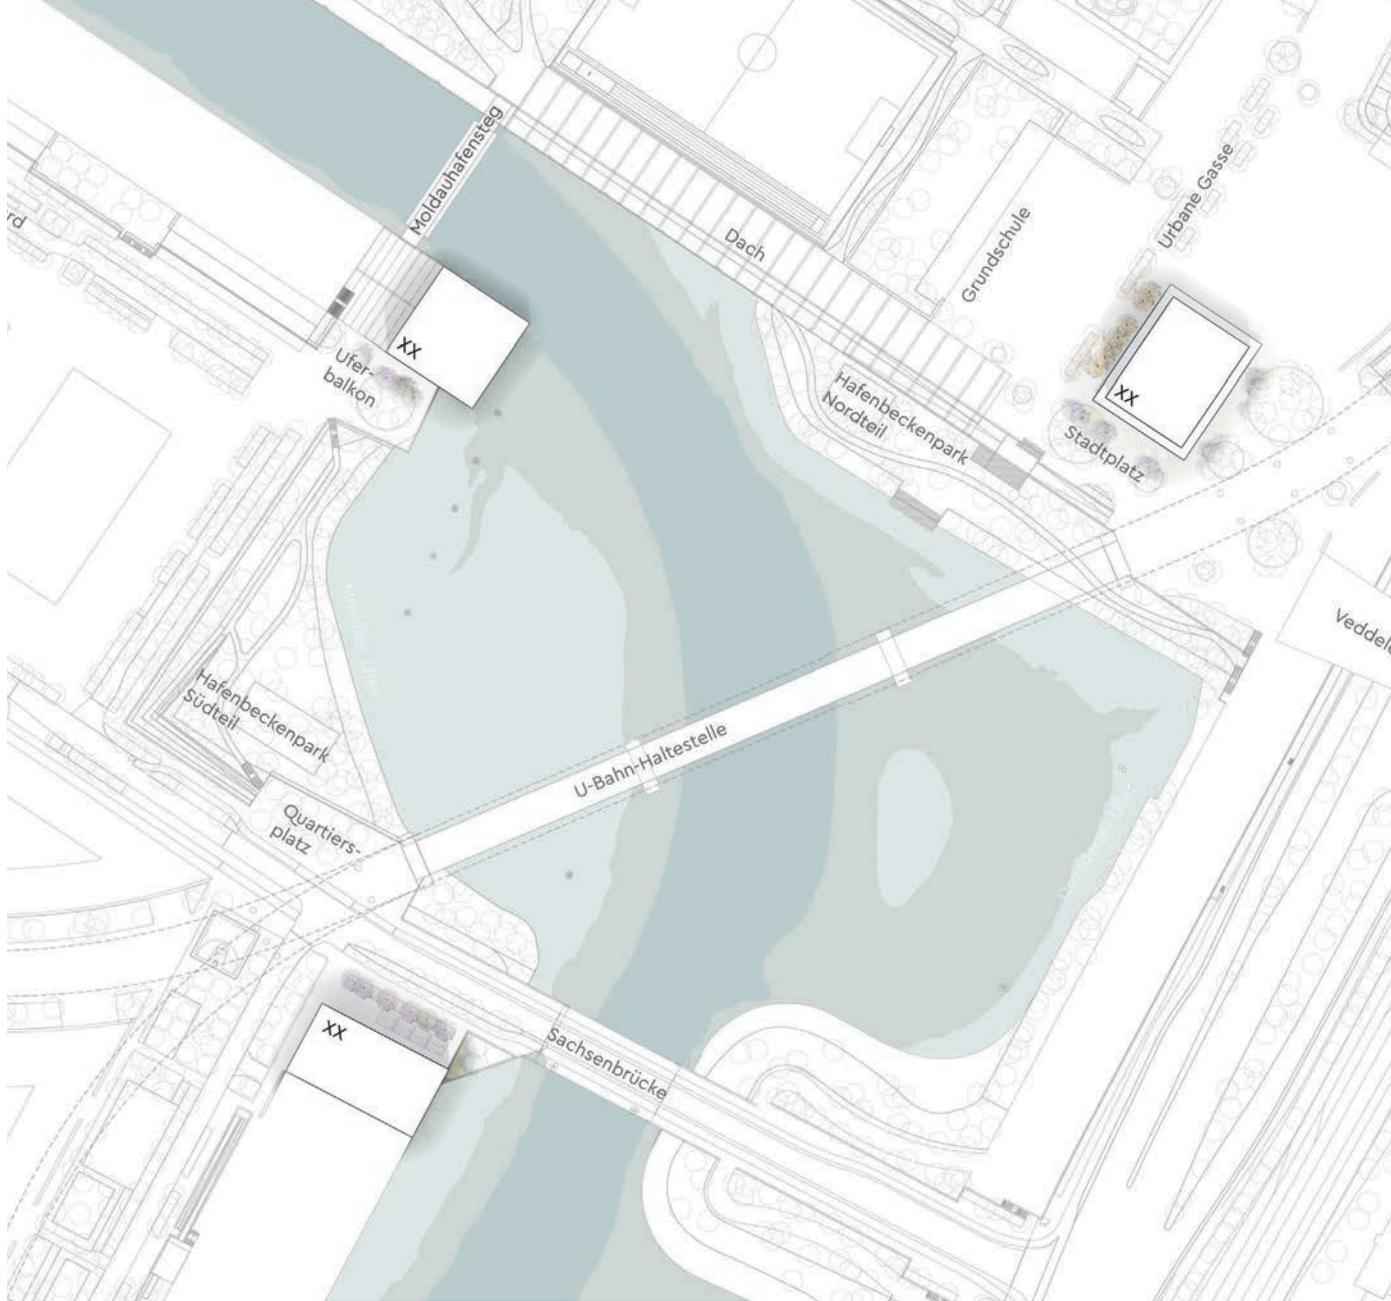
Lageplan Baufelder 20, 26 und 32
